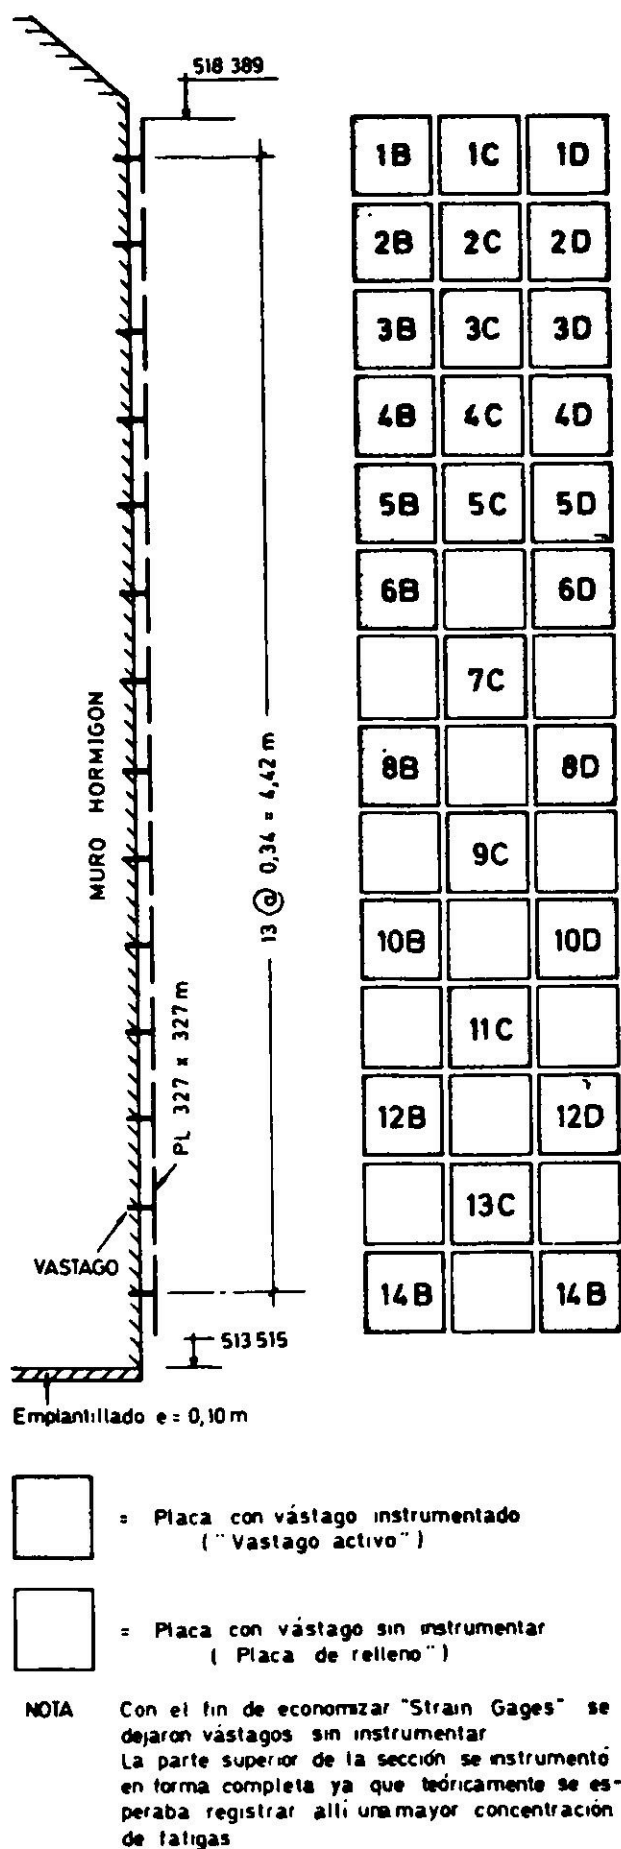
Disposición de las placas con vástagos activos instaladas en el muro del túnel.
